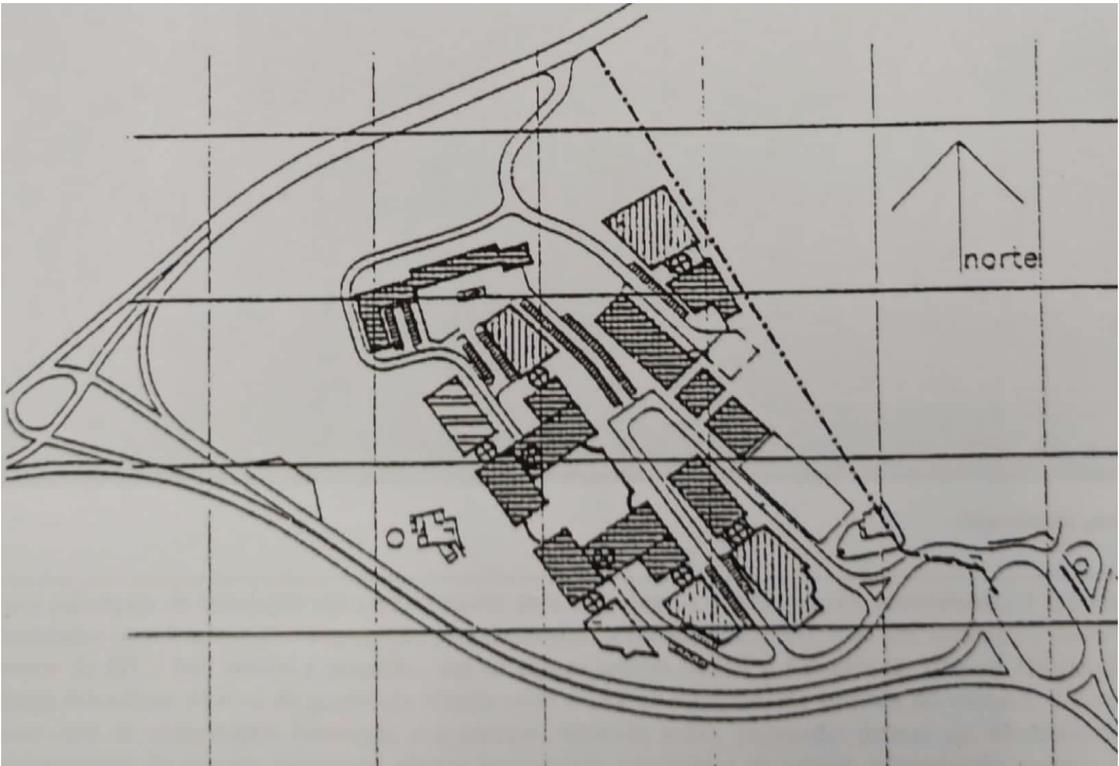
Plano de Pormenor do Polo III por Rebello de Andrade.
